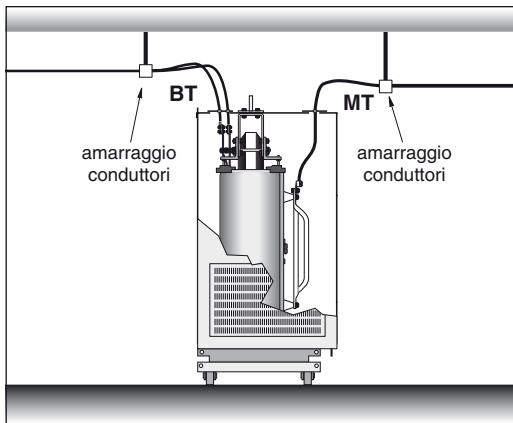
collegamenti MT e BT provenienti dall'alto.
